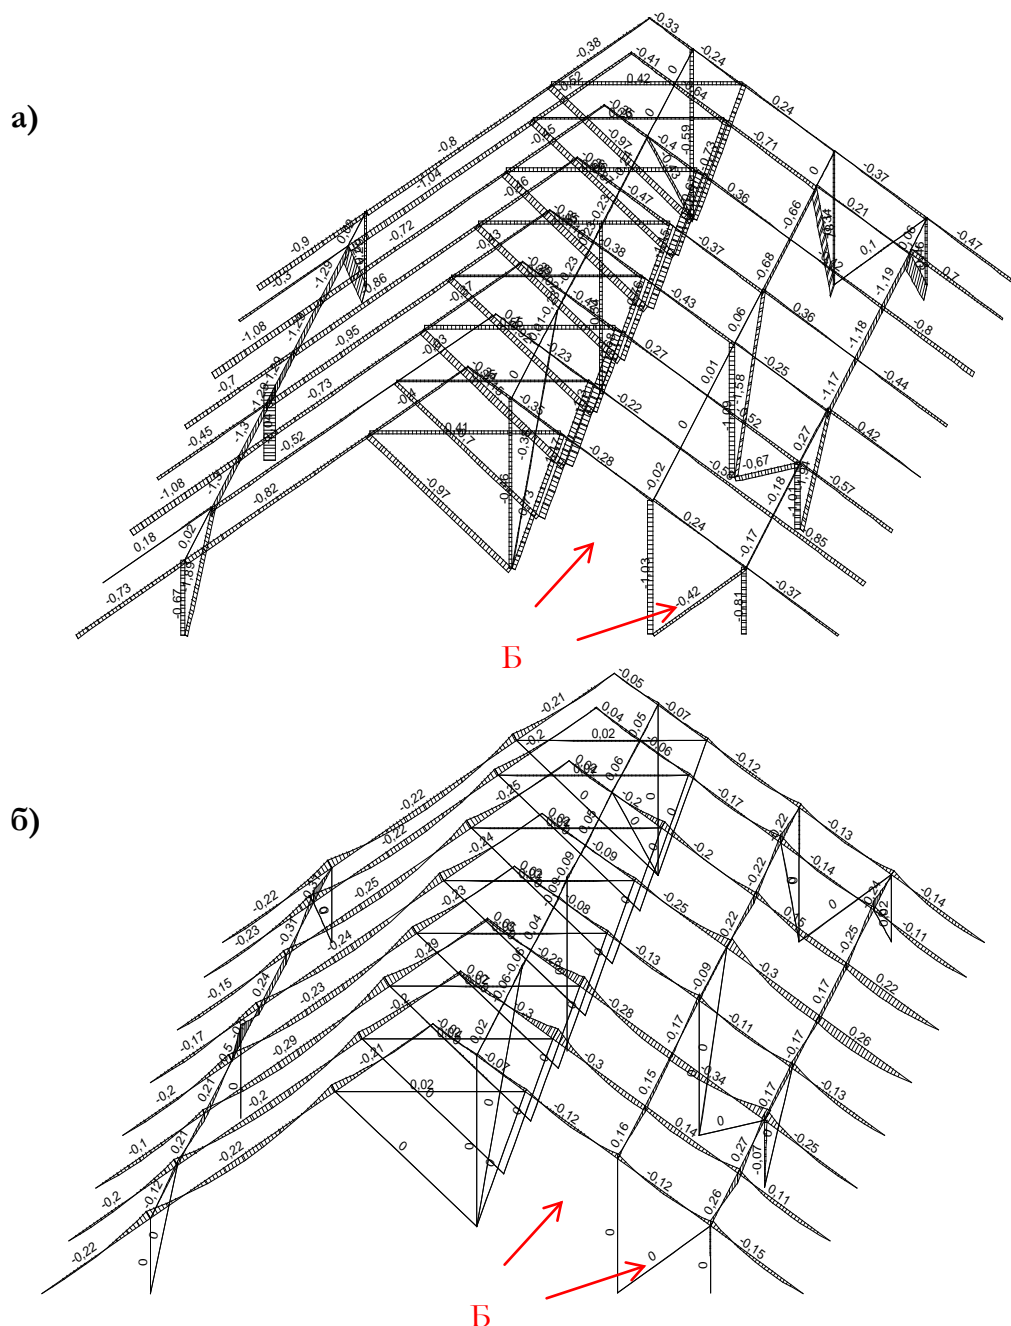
Эпюры внутренних усилий в поперечных сечениях стропильной системы с двумя промежуточными стойками (Б) от расчетных значений нагрузки: а) эпюра продольных сил N , тс; б) эпюра изгибающих моментов M , т×м;
